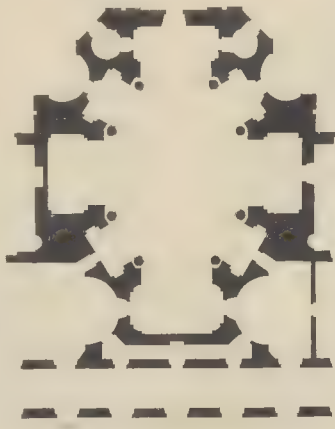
GRUNDRISS DER HOSPITALKIRCHE
